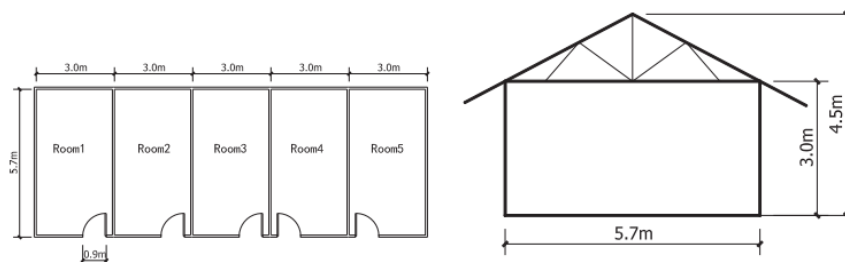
Grundriss (links) und Schnitt (rechts) des Versuchsaufbaus [221]
